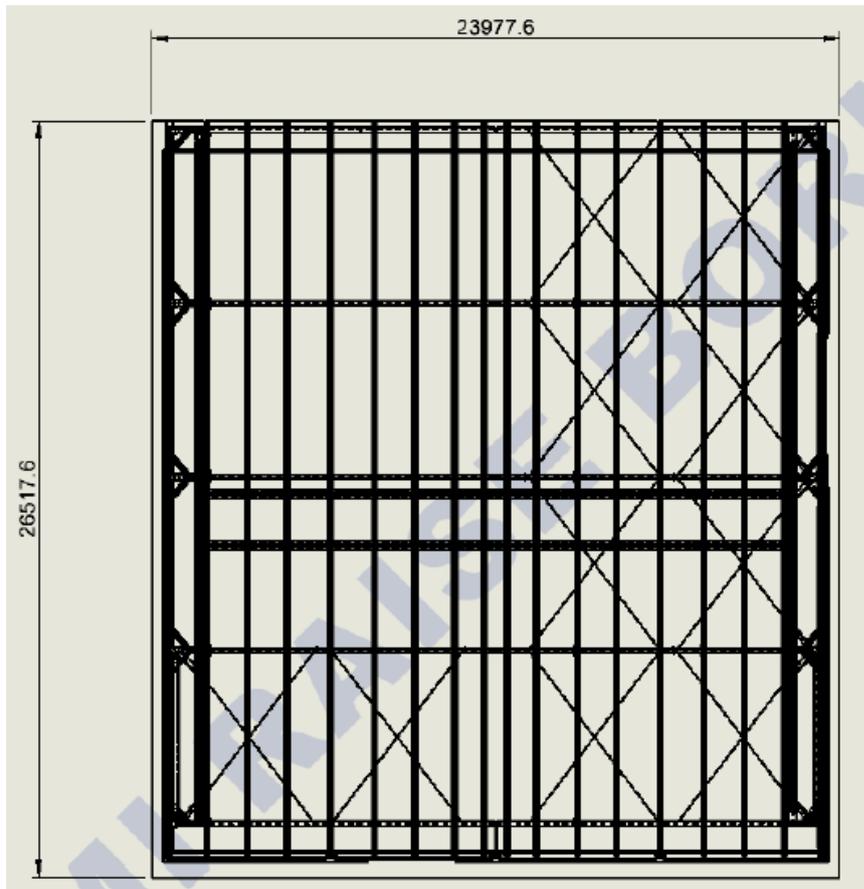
Dimensiones en milímetros de la Nave para el área de soldadura (vista de planta).
